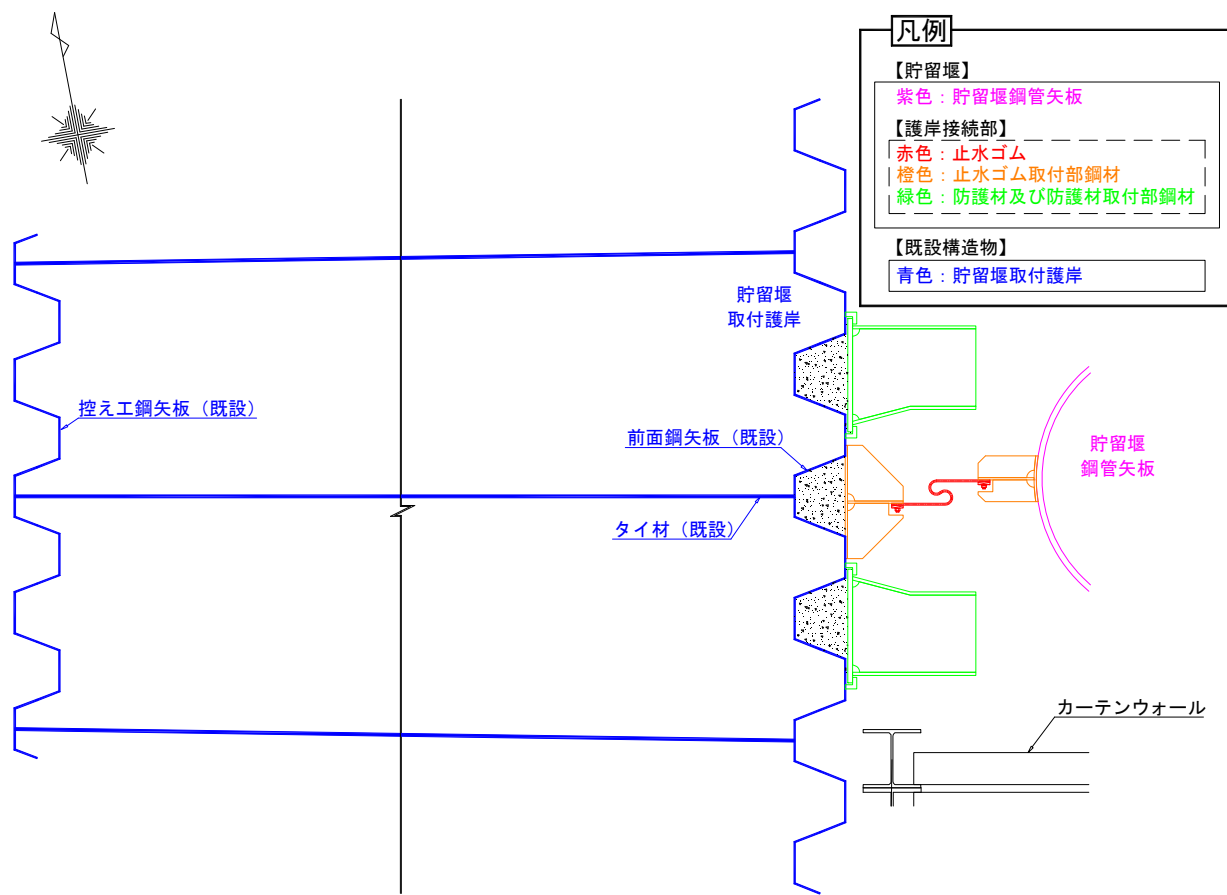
(2) 貯留堰の平面図 (A 部拡大)
